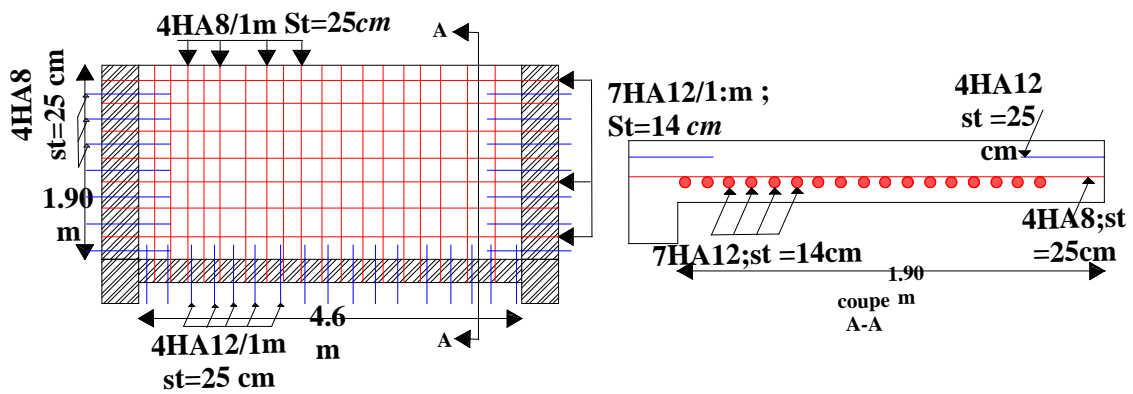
Schéma de ferrailage de la dalle sur type 3
